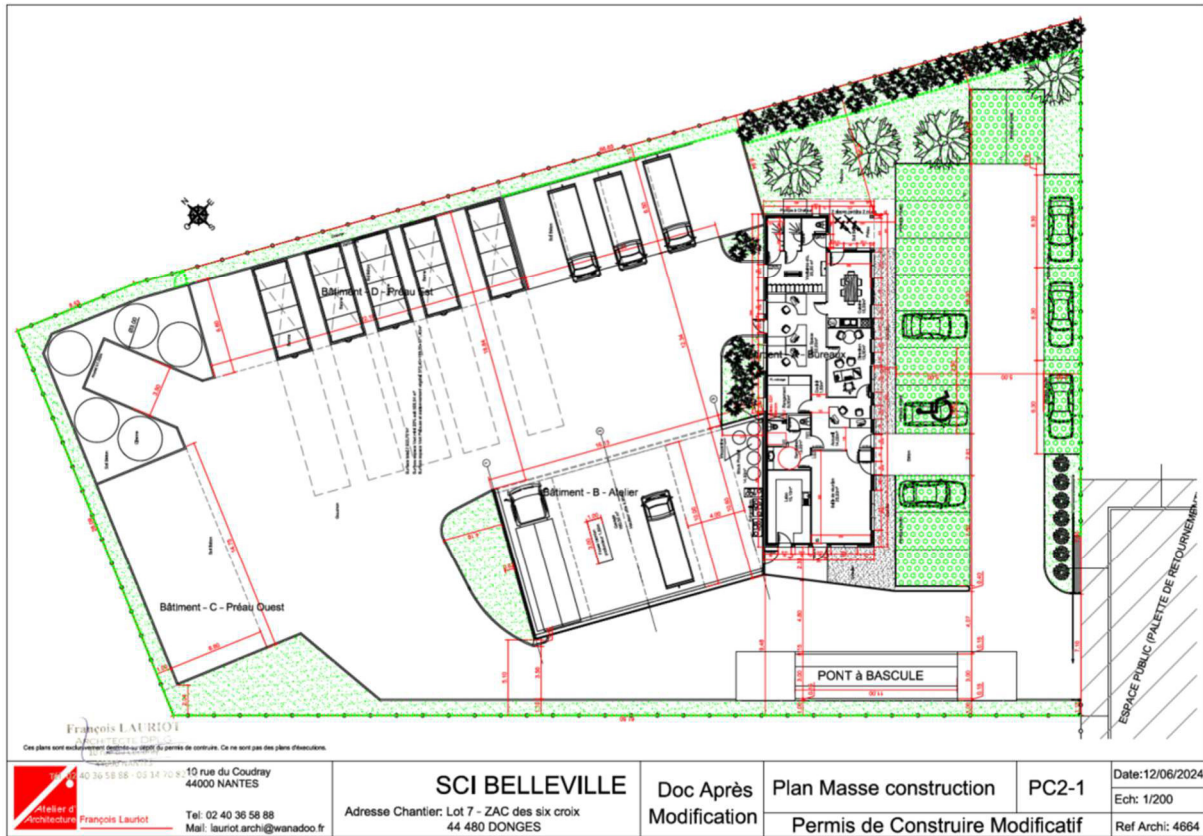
Plan projet de recollement d'avril 2024 (Source : Client)
